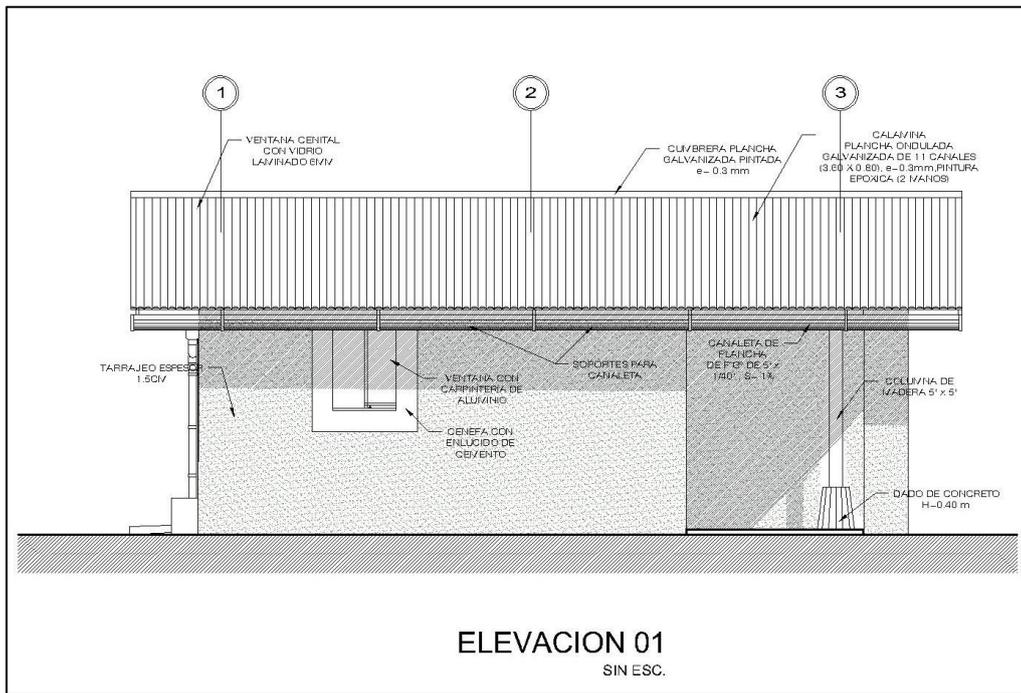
Diseño de vivienda con muros de botellas PET. Vista elevación 01
